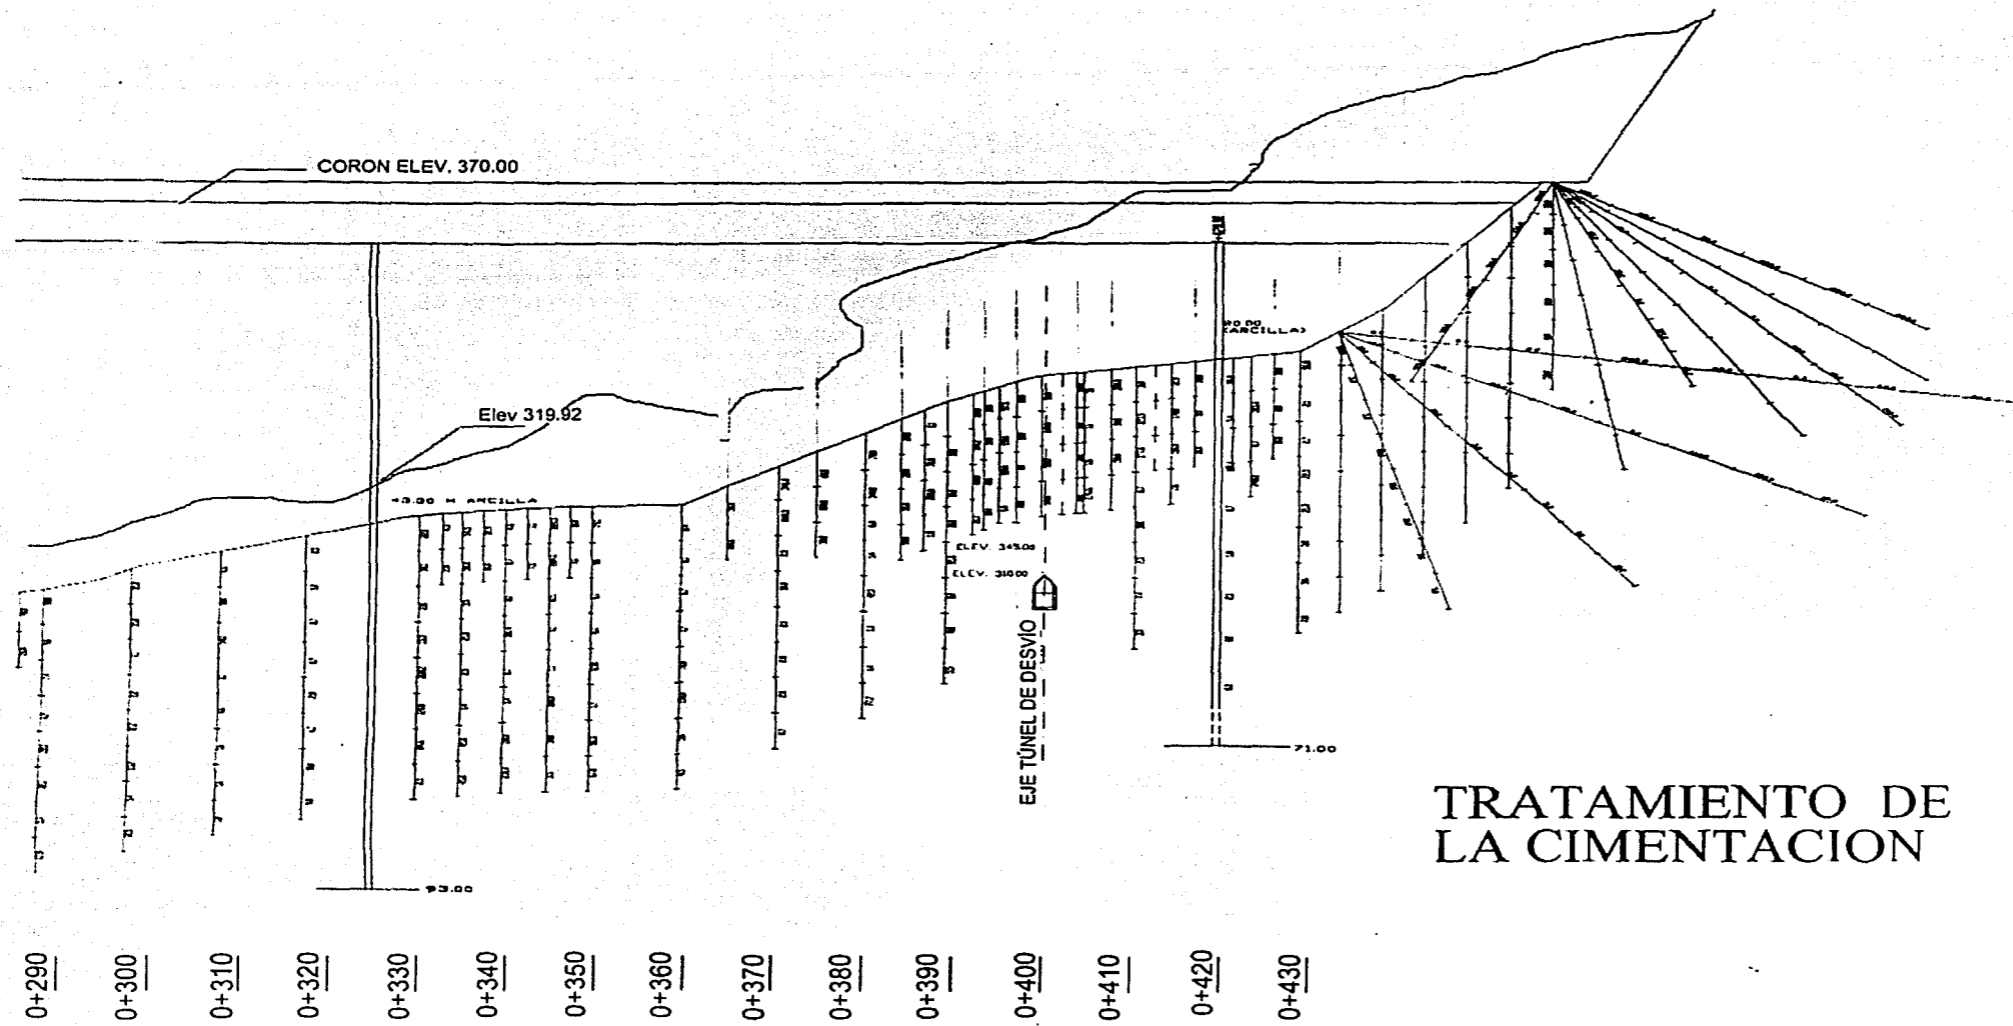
Tratamiento de cimentación. Corte. Longitudinal Ladera Derecha
